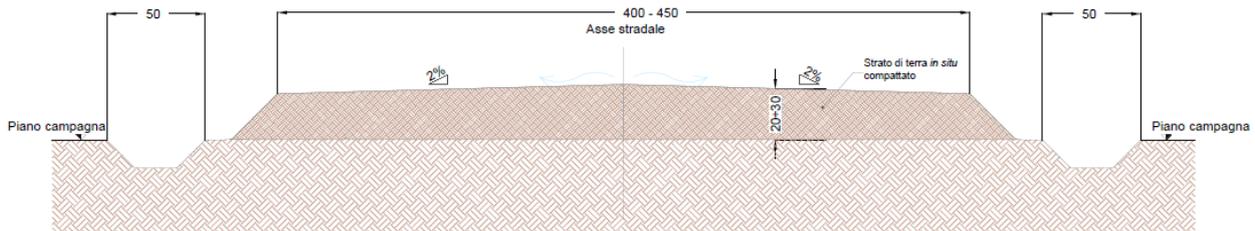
Sezione tipo di strada bianca in terra battuta, misure in cm
